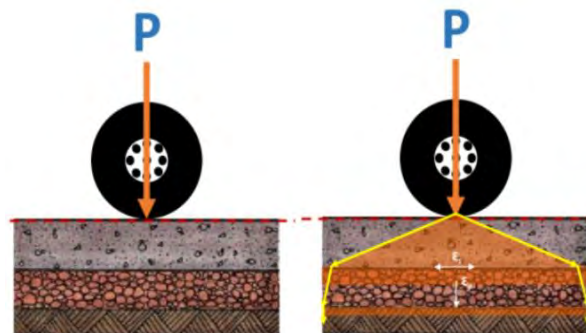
Distribución de esfuerzos en pavimento rígido (Pacasmayo, 2009)
